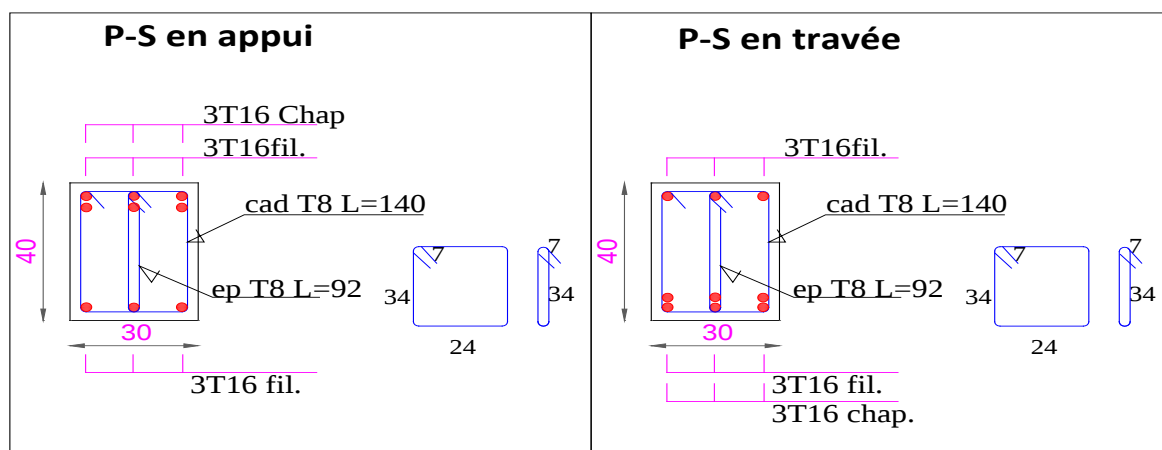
Ferrailages des poutres secondaires (30X 40).
